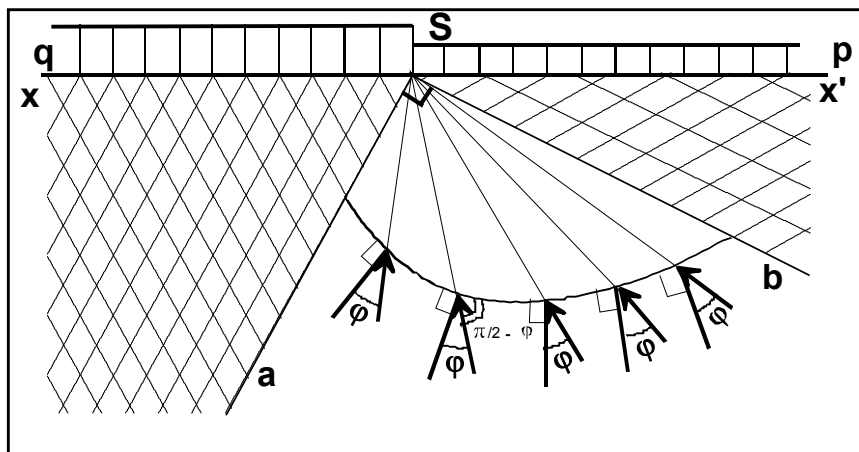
Mécanisme de rupture d'une fondation de base lisse (Prandtl (1920))
